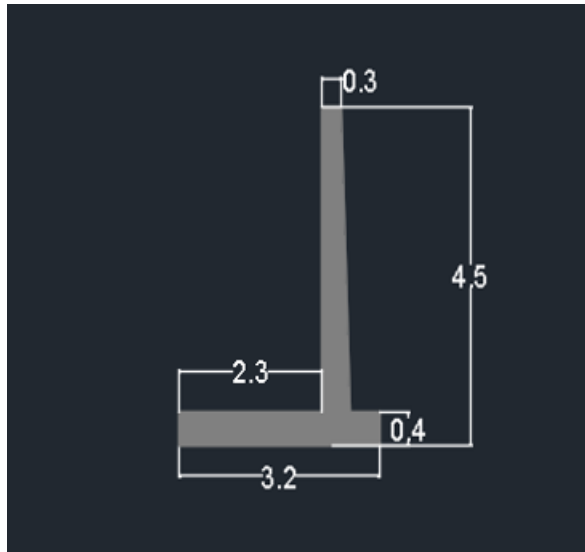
Dimensionamiento Muro de contención K0+260– K0+280
